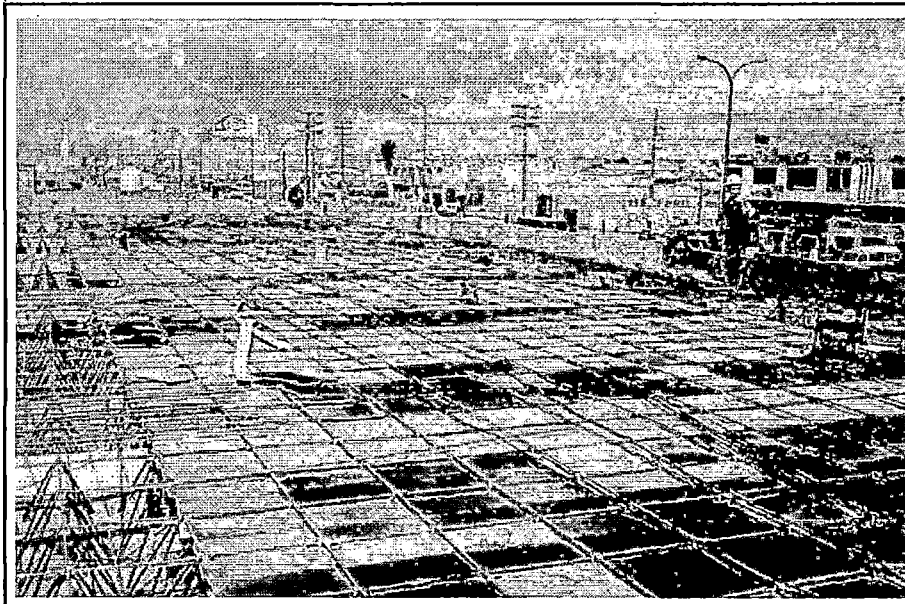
Esquema de colocación de una plancheta sobre las crucetas de soporte
